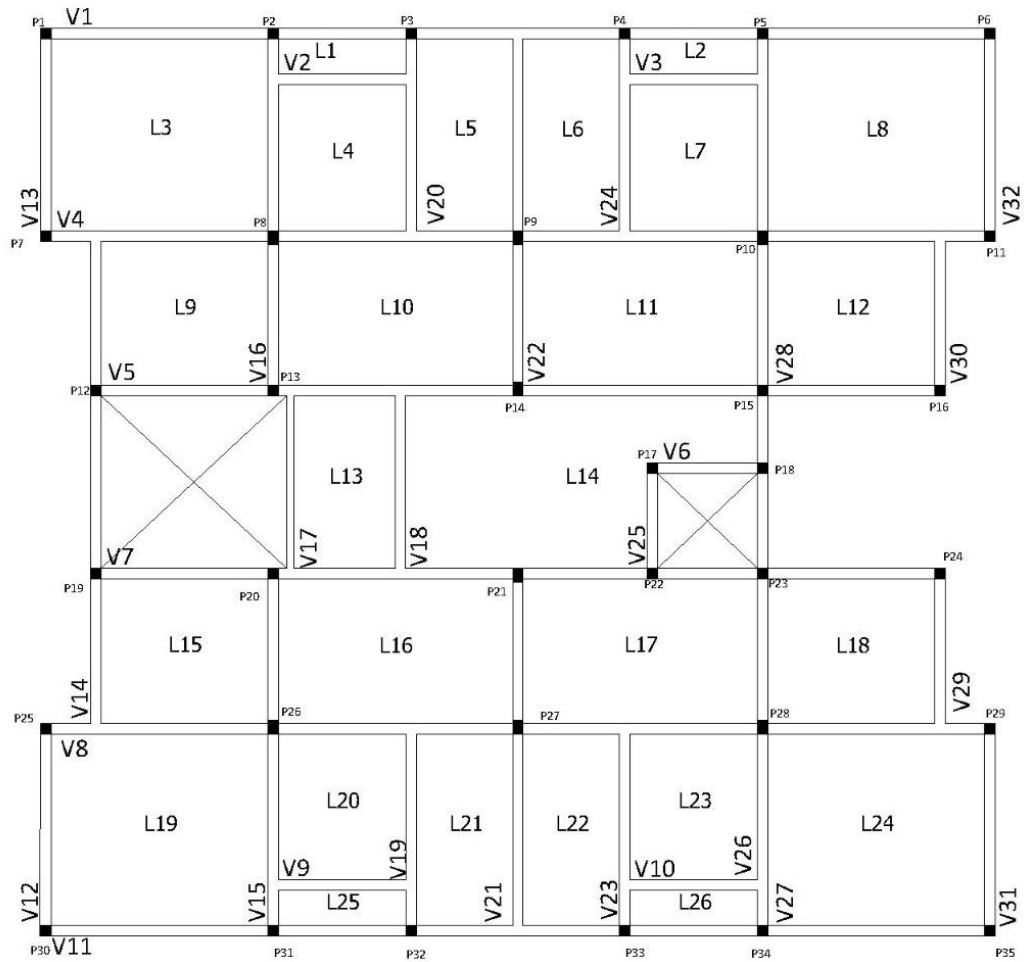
Localização das vigas e lajes da primeira concepção estrutural (Fonte: autor próprio)
